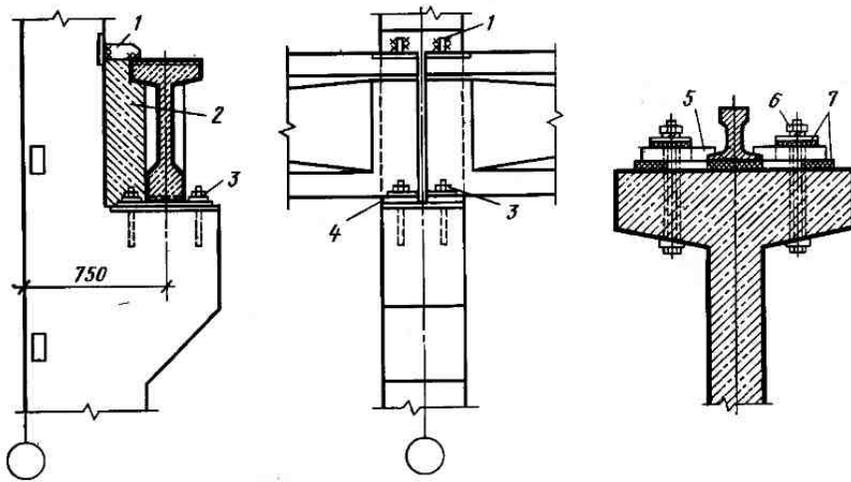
Конструкция крепления железобетонной подкрановой балки:
